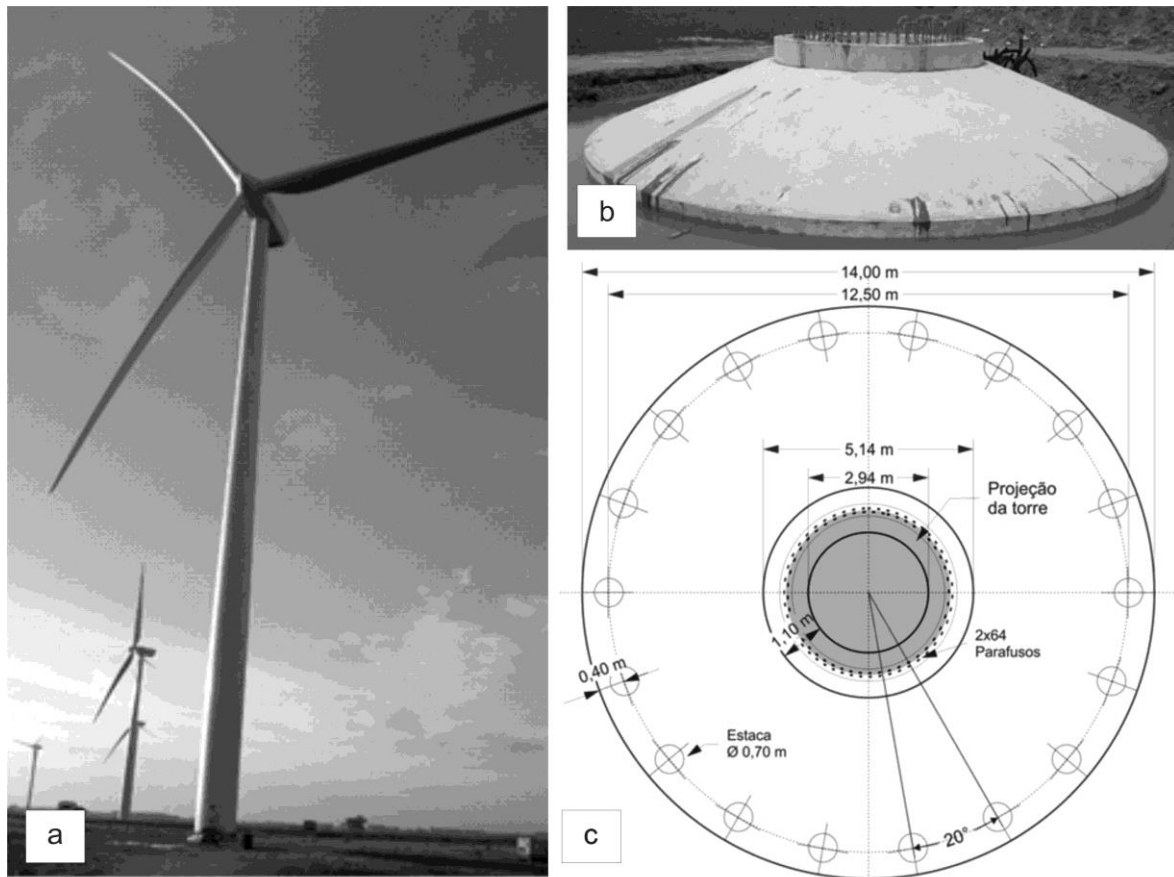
Torre eólica (a); Base (b); Planta da base (c)
